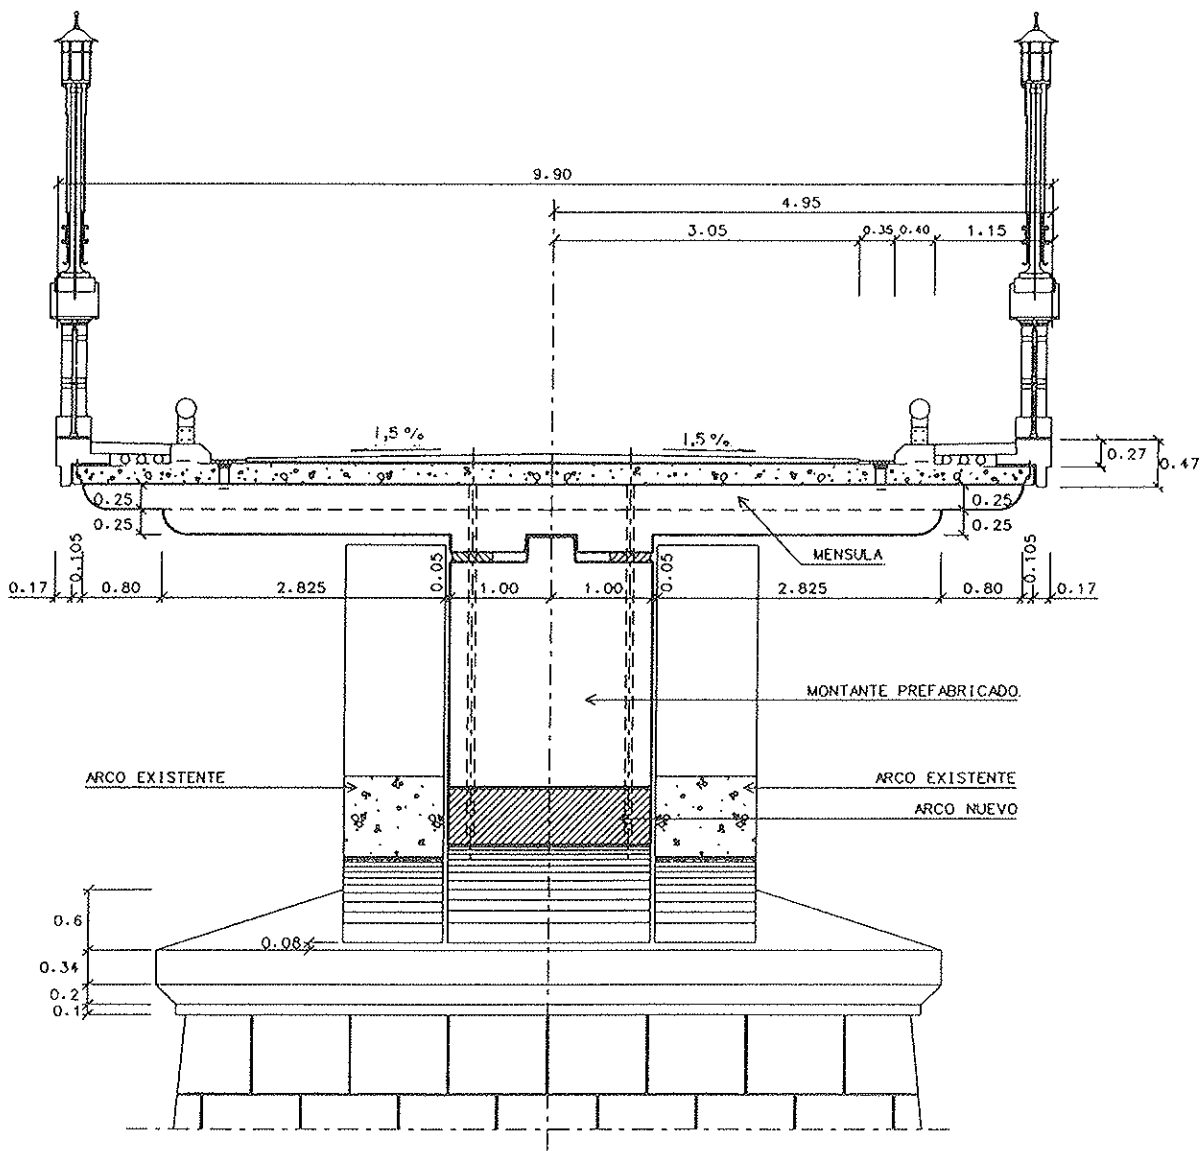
Puente de Villanueva de Castelló. Sección transversal por pila.
